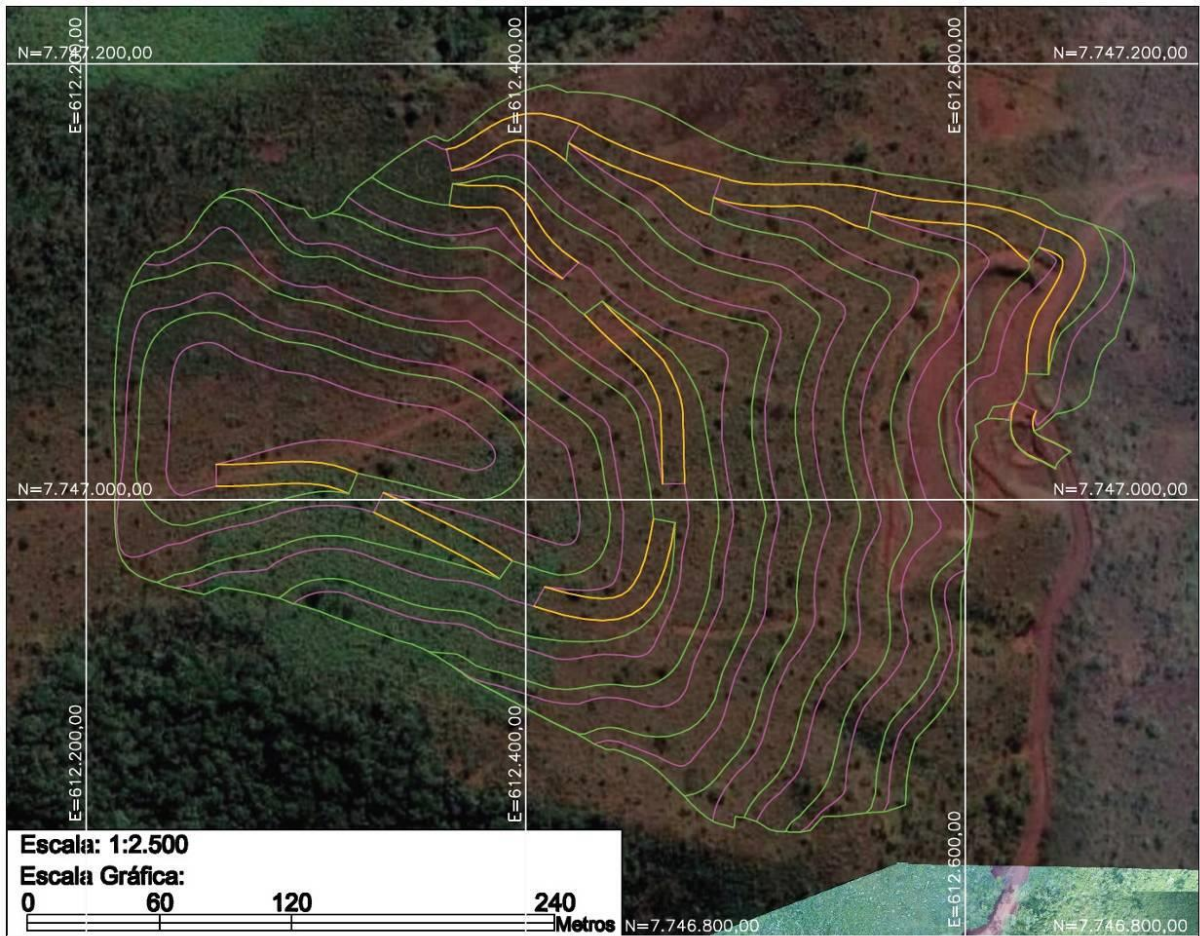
Planta da configuração final da Pilha Curral, sobre imagem de satélite.
